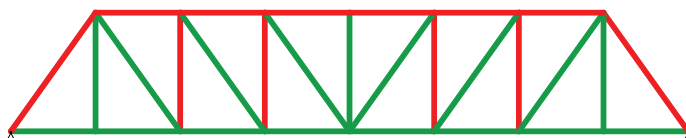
Solução B: Solicitações nos elementos da viga principal interior
